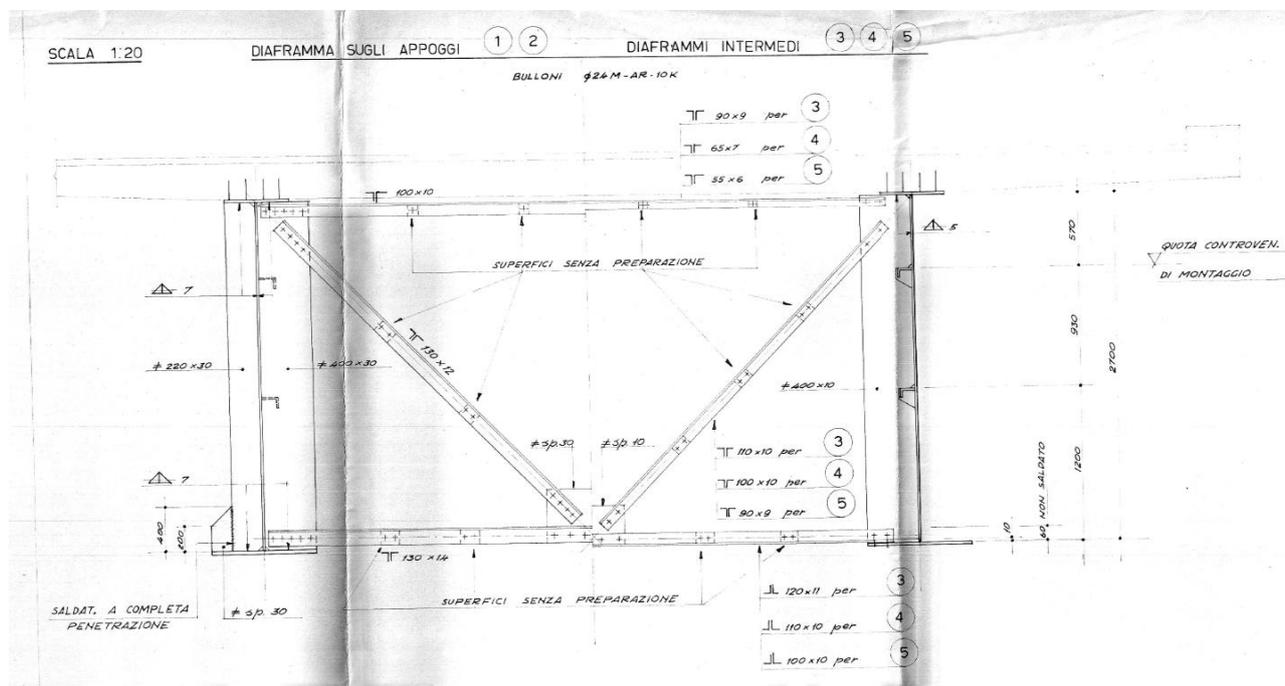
Impalcato campate di scavalco linea FS – Sezione trasversale
